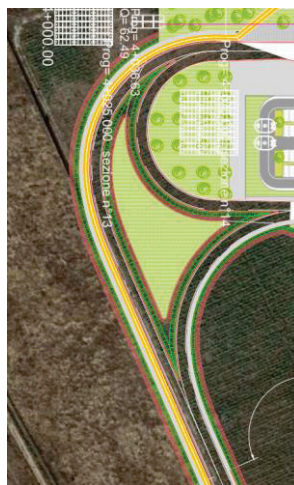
Stralcio planimetrico NV01B-viabilità interna al piazzale
